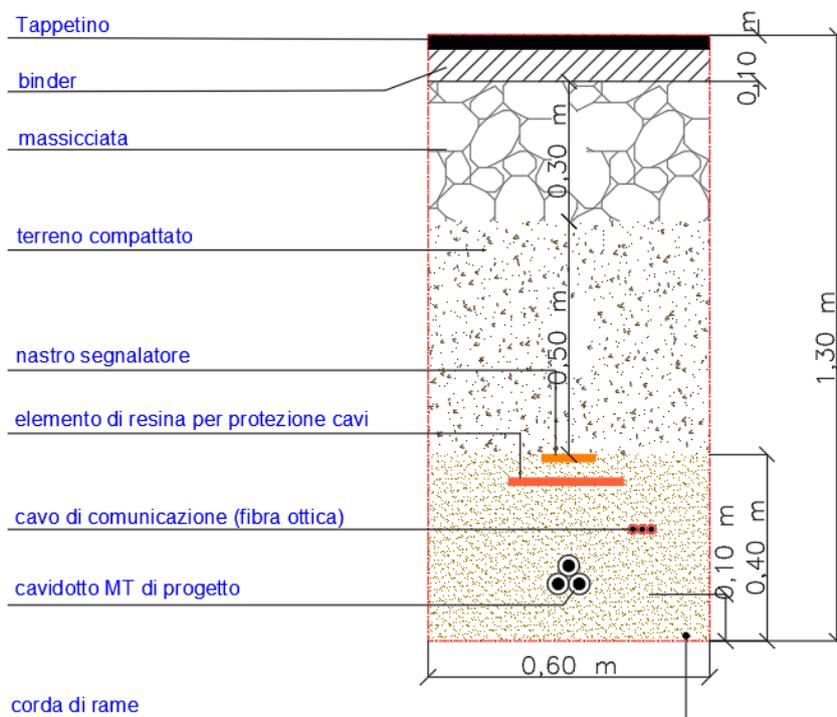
Sezione Cavidotto singola terna di cavi su Strada Asfaltata
